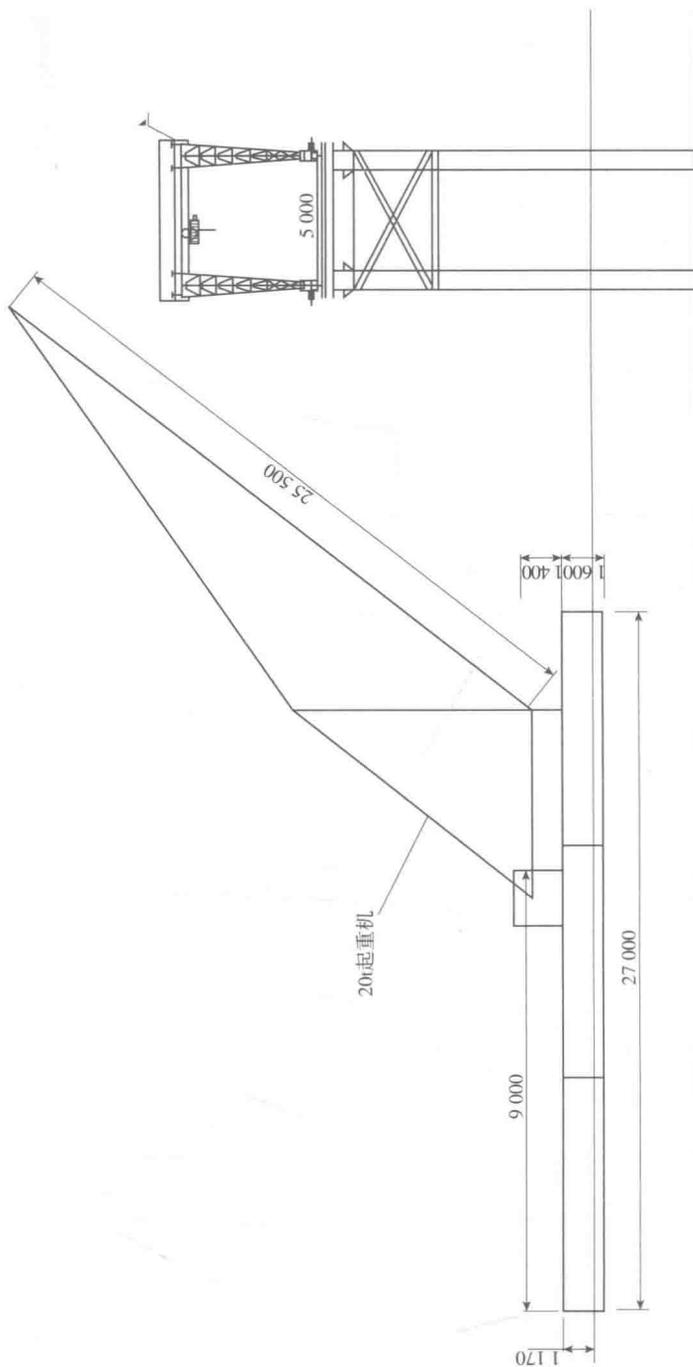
水上桩基钻孔平台体系侧面图(尺寸单位:mm)
